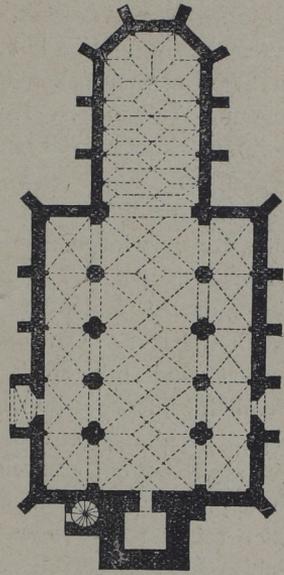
Grundriss der Veitskirche in Krummau.
